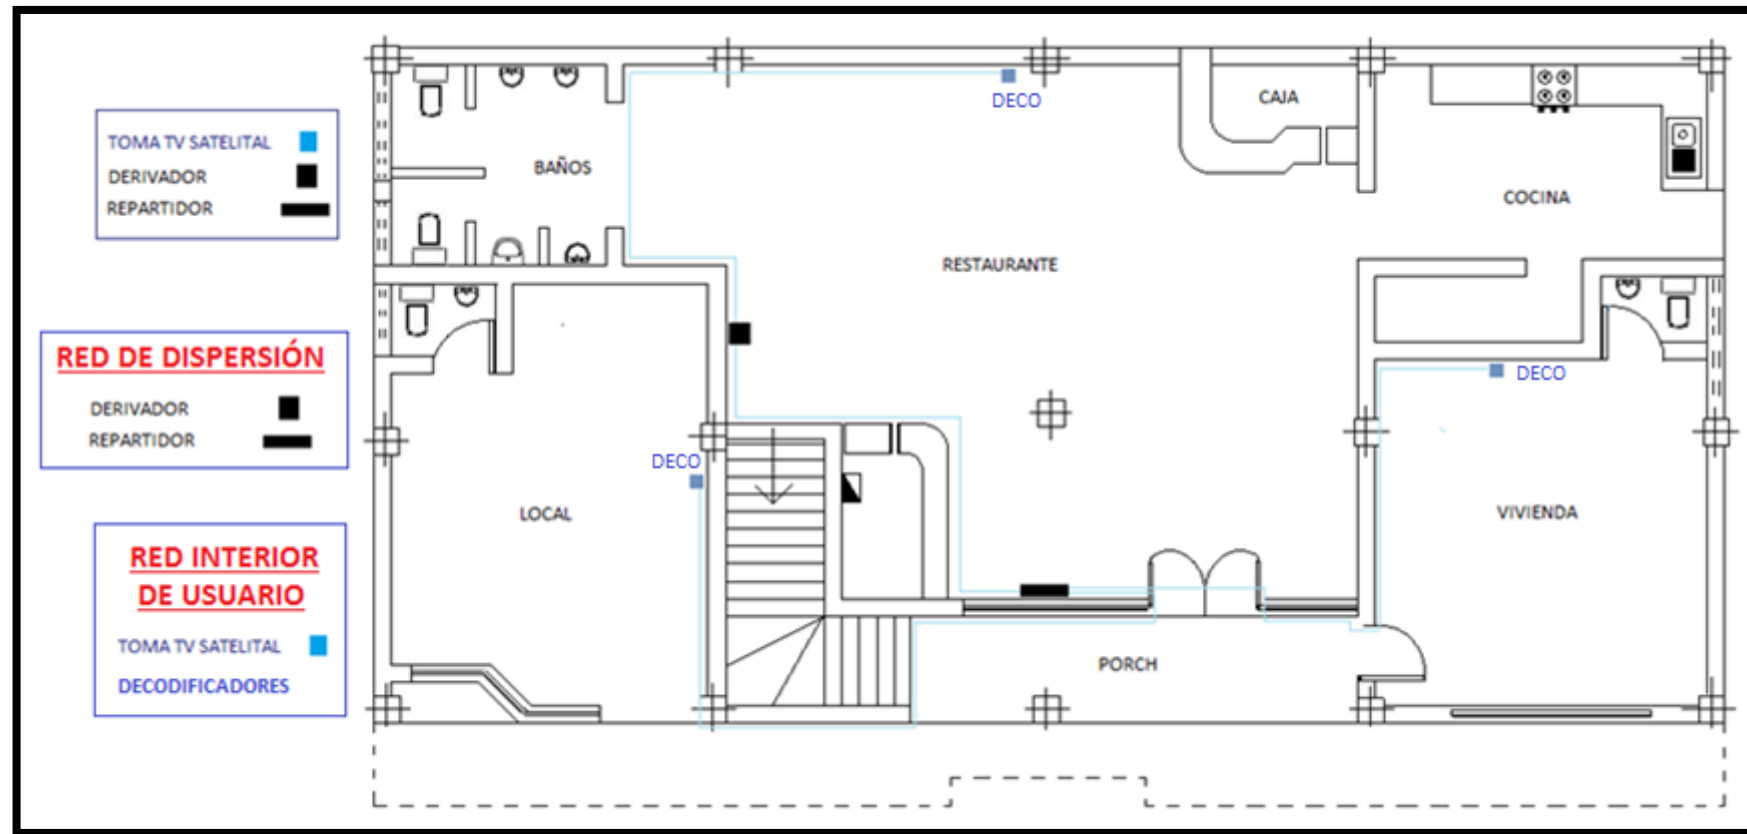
Puntos de TV satelital – Plano Planta Baja
